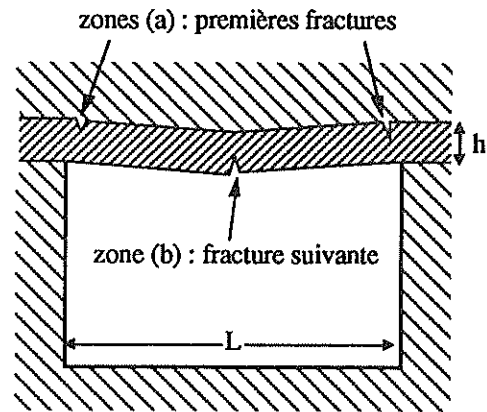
Emplacement des premières fissures affectant le premier banc, au toit d'une galerie rectangulaire
